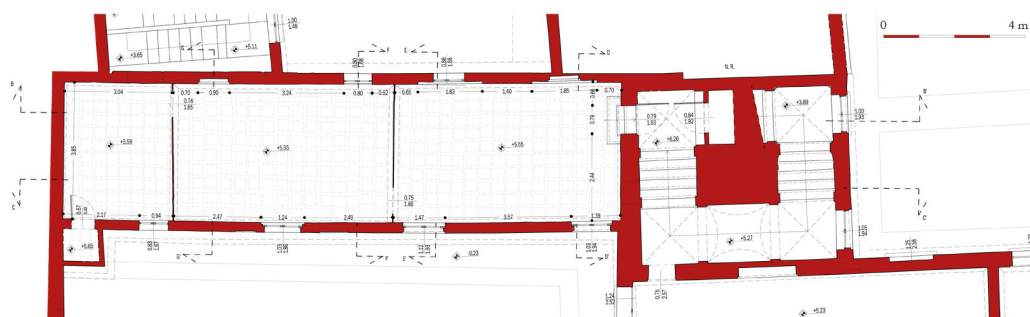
Dettaglio della pianta del primo piano di Casa Romei. Tutti gli elaborati sono stati restituiti in scala 1:50 (disegno dell'autore).
